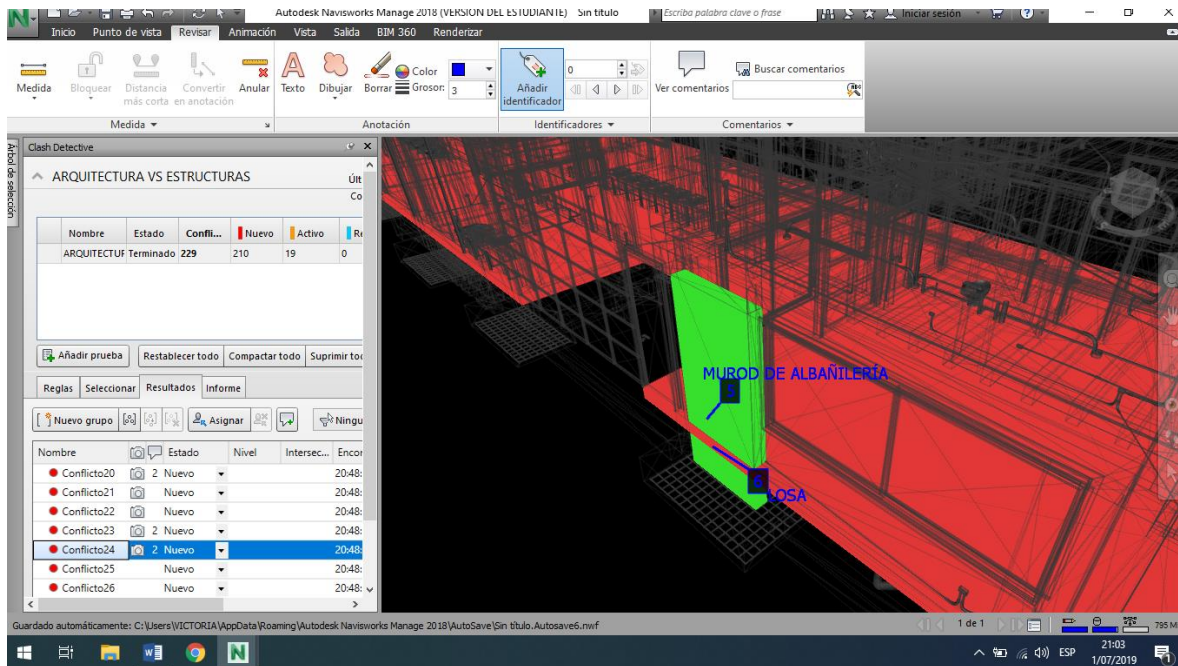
Interferencia entre muro de albañilería y losa de concreto.
